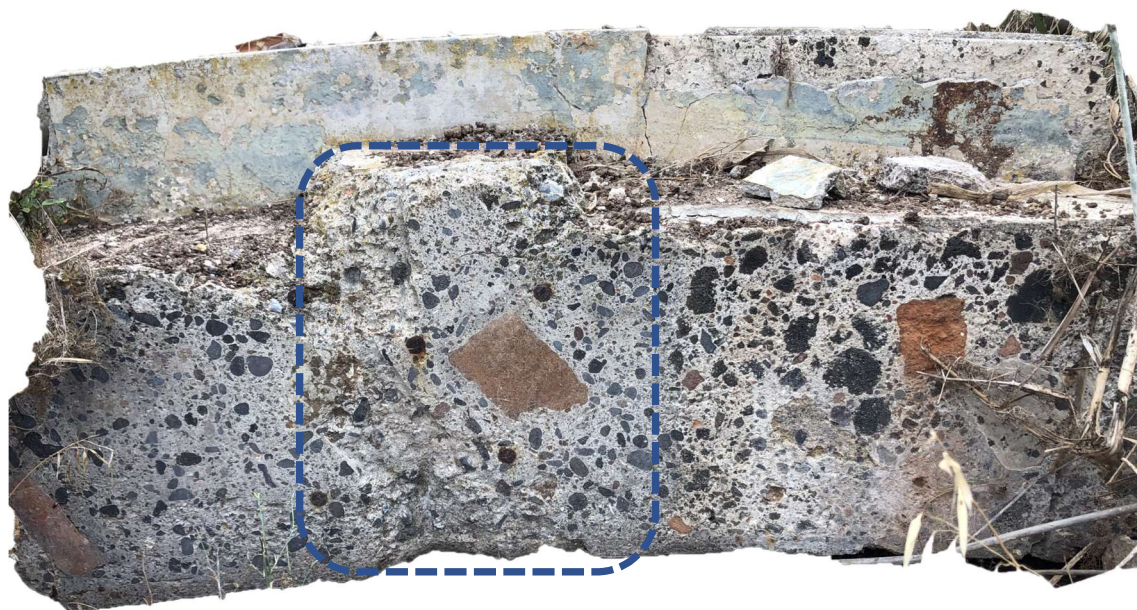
, detalle de corte horizontal del muro del tambor por encima de las ventanas, en el que se aprecia la armadura de las pilastras, señalado con el rectángulo azul.
